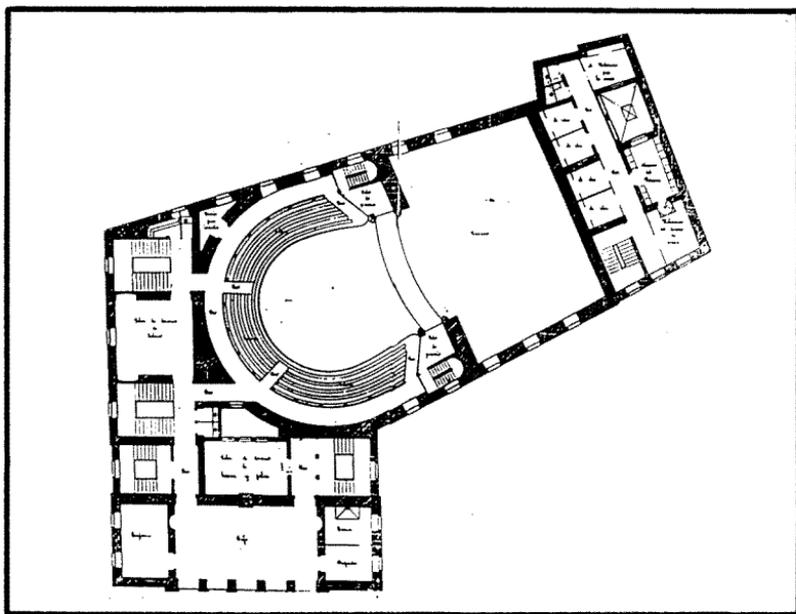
Proyecto de Amador de los Ríos. Planta primera, 1870. (A.M.T.).
